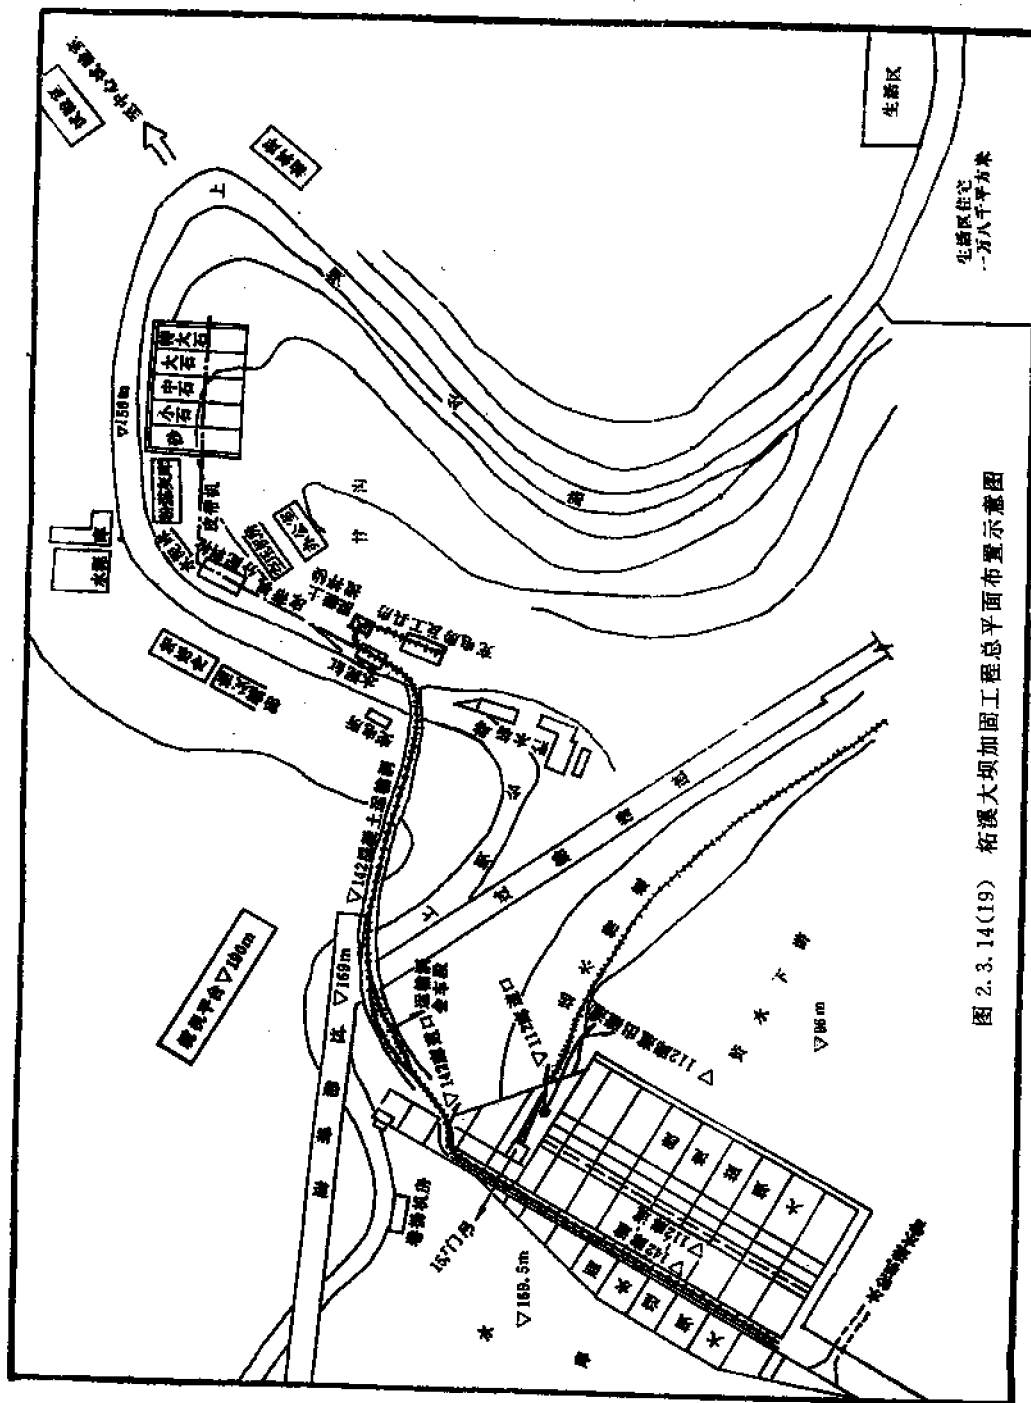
(19) 柘溪大坝加固工程总平面布置示意图
